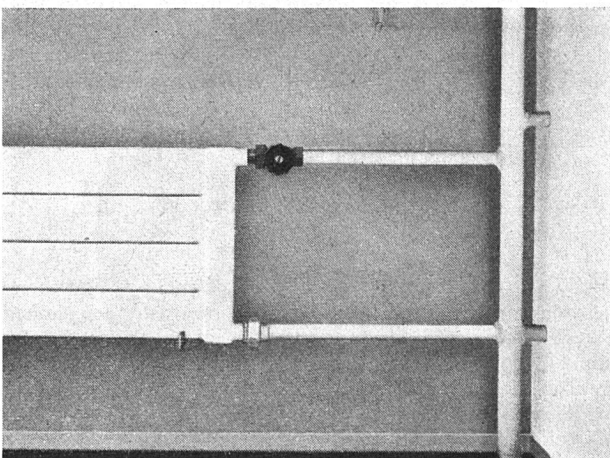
Radialer Anschluss bei Einrohrheizung (senkrecht System).
